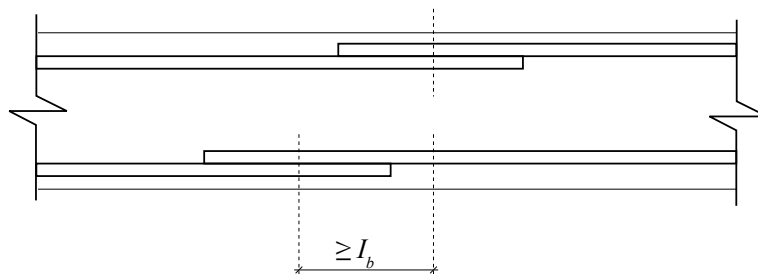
Solape de barras en tracción (Figura 49.5.2.1 del Código Estructural)
